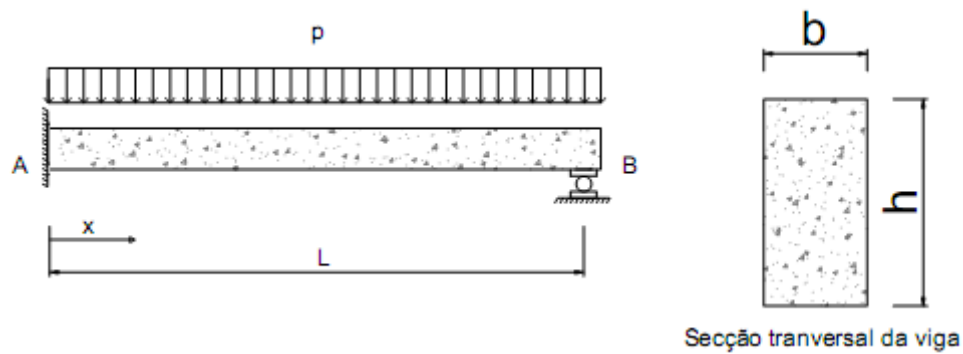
Viga encastrada – apoiada (exemplo 2.2.1)
